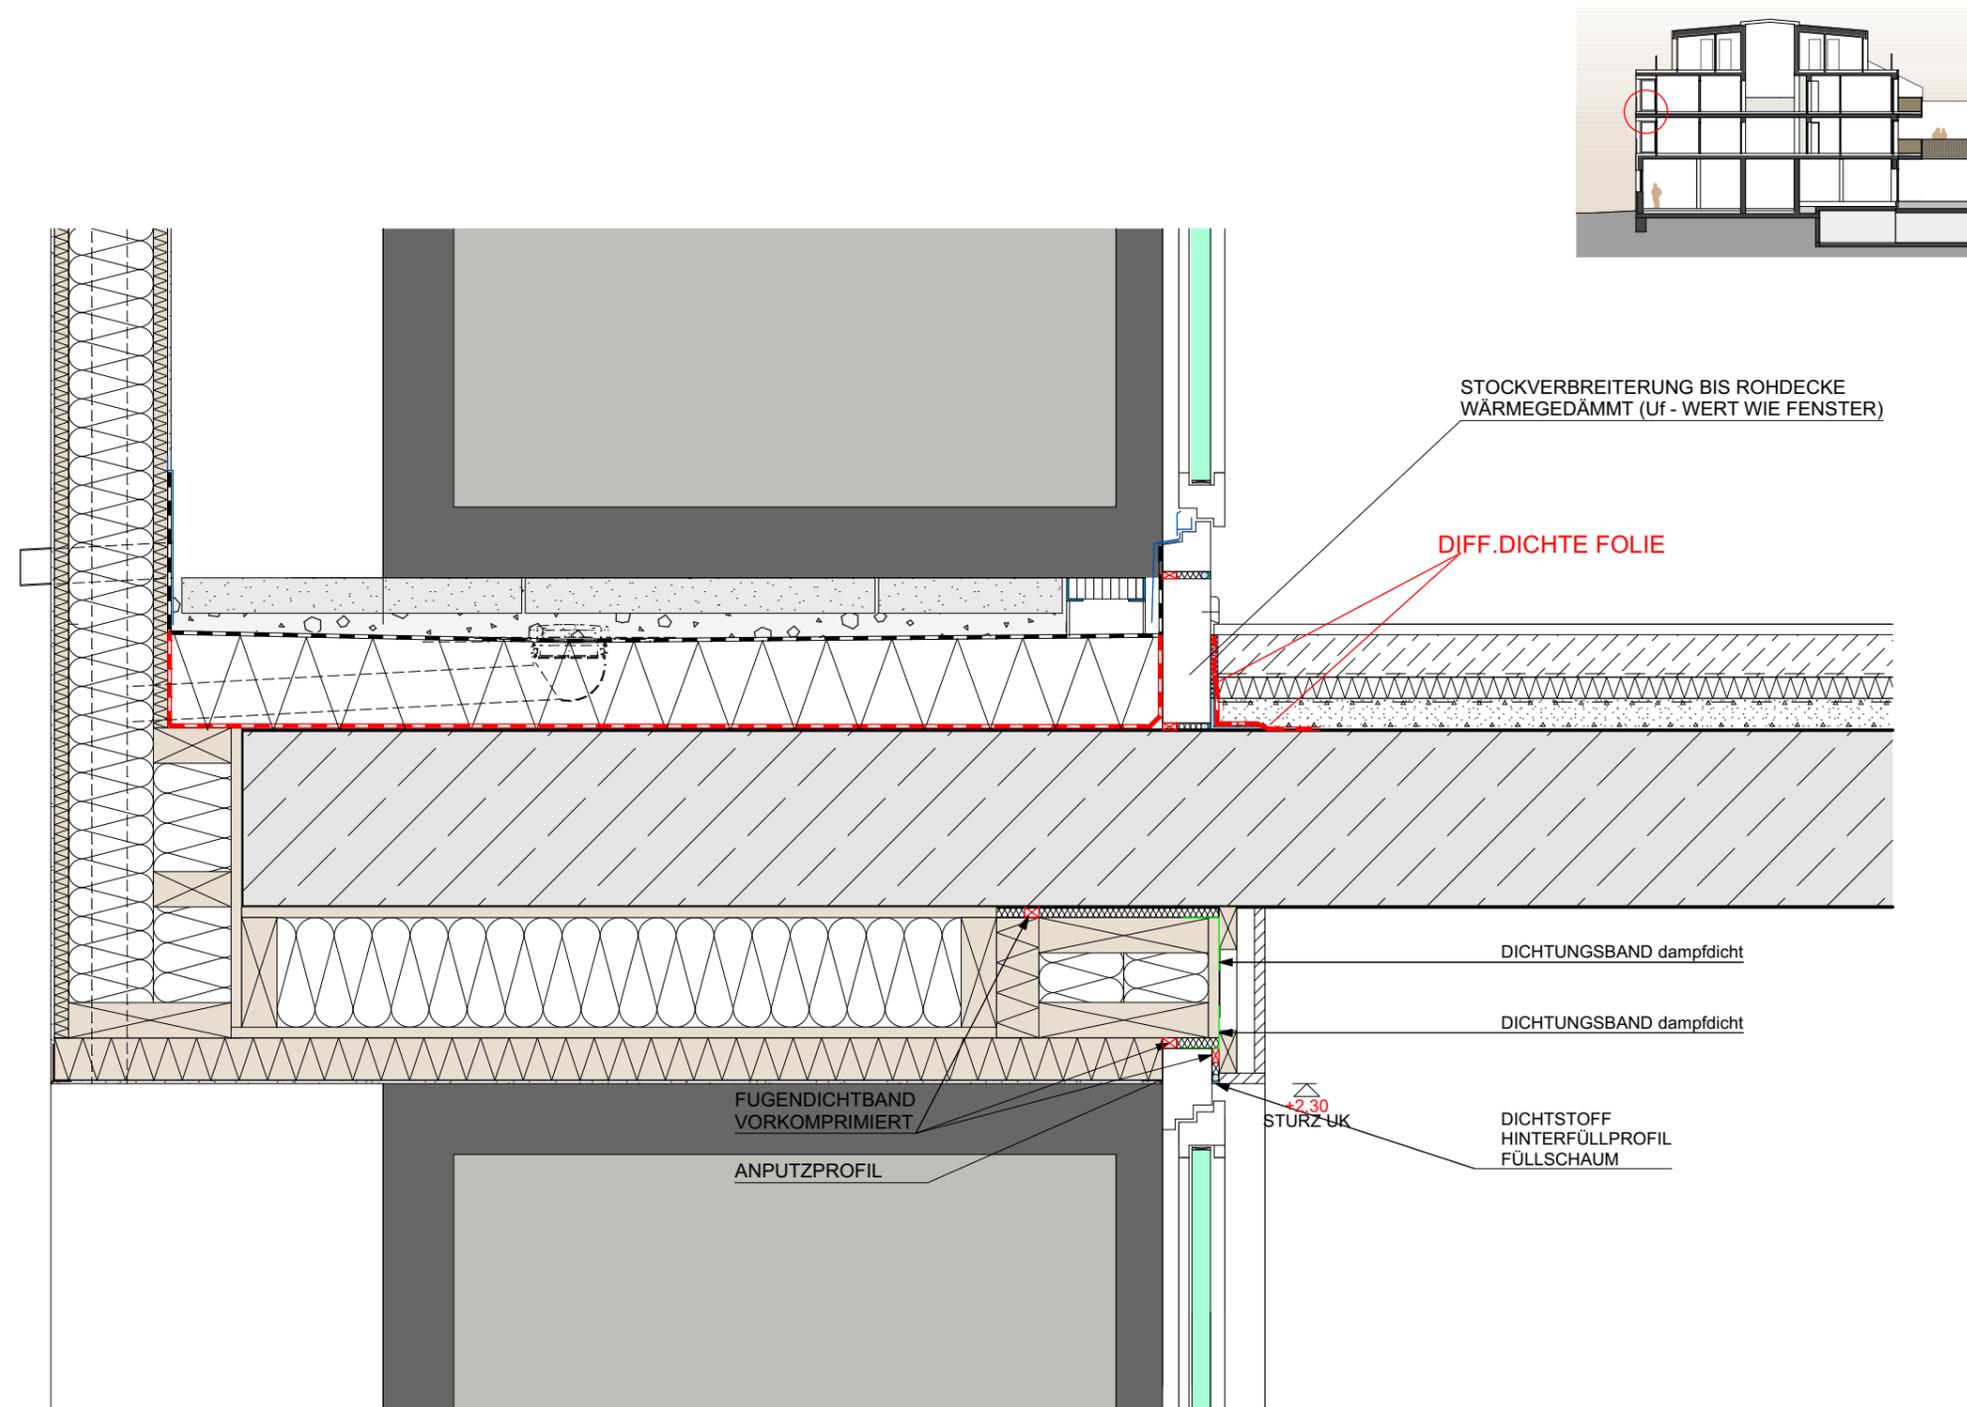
Bauteil 1: Aufbau Loggia 1:10
